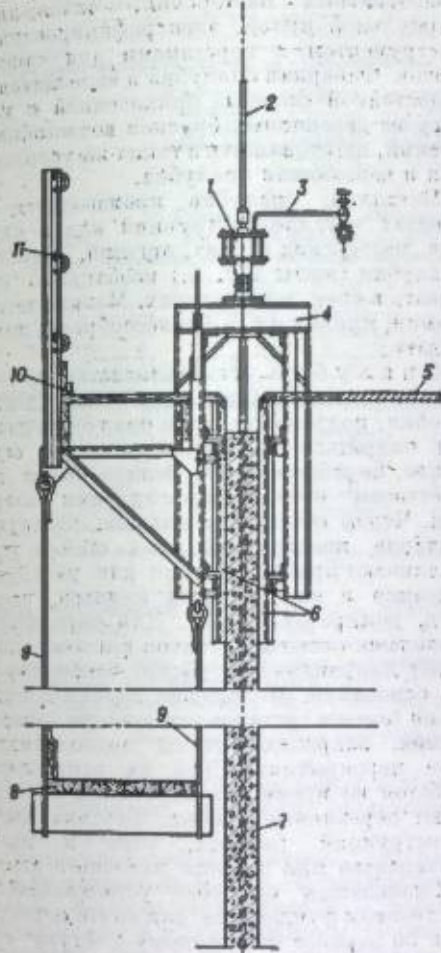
Подвижная (скользящая) опалубка: 1 — гидродомкрат; 2 — домкратный стержень; 3 — гидроразводка; 4 — домкратная рама; 5 — рабочий пол; 6 — стенки опалубки (форма); 7 — готовая стена; 8 — подвесные подмости; 9 — подвески подмостей; 10 — козырек; 11 — ограждение.
